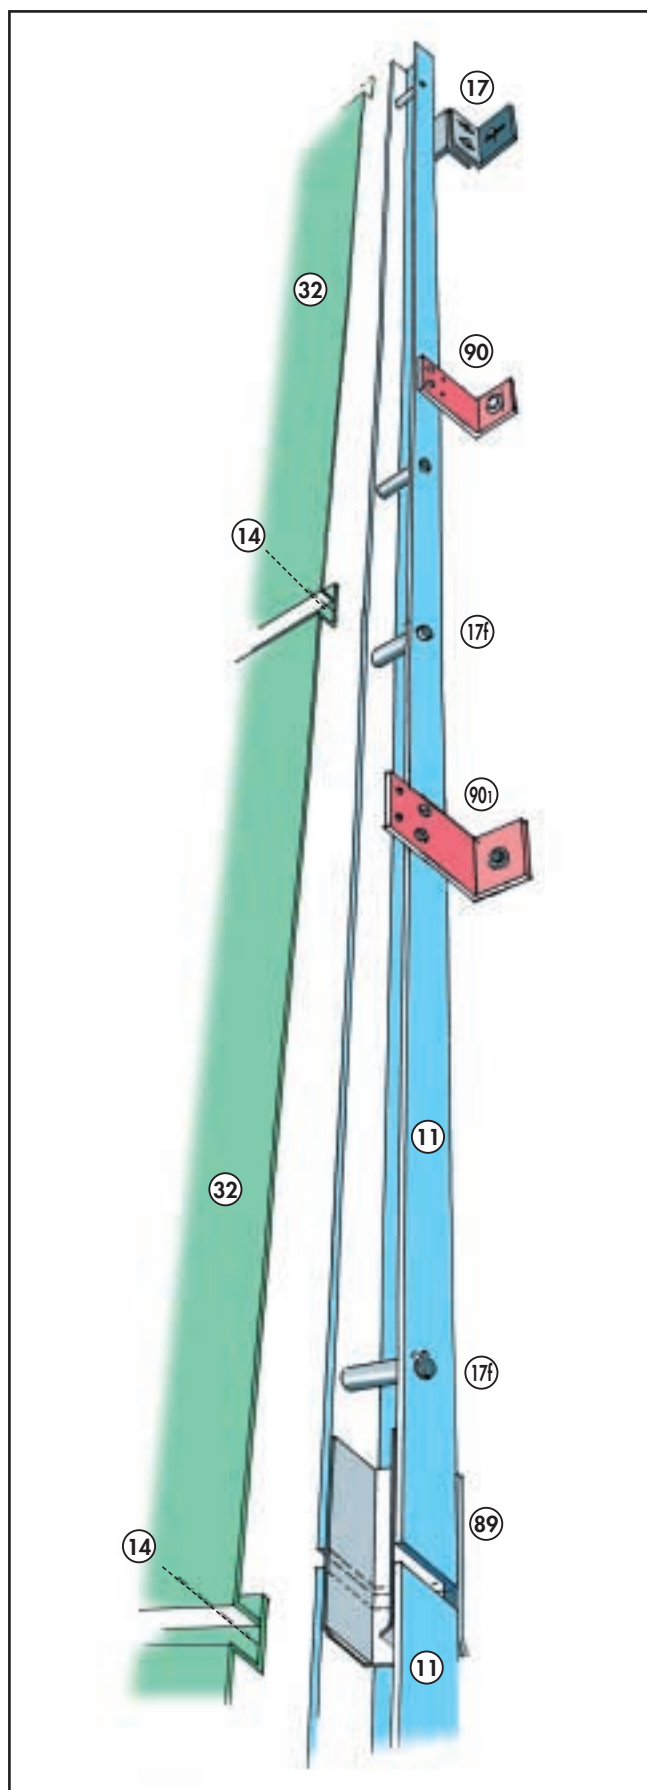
a) - Irrigidimento del montante con gli attacchi (90): notare la diversa posizione dei due attacchi, per compensare irregolarità della parete
